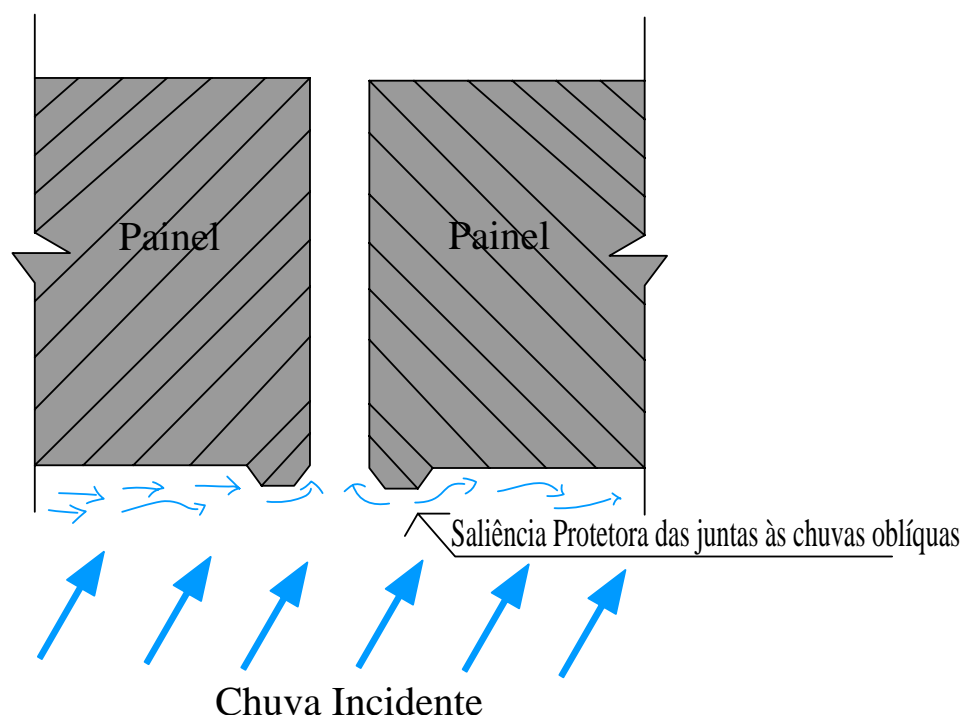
Vista em corte de uma junta vertical entre dois painéis – Adaptada PEREZ (1985)
